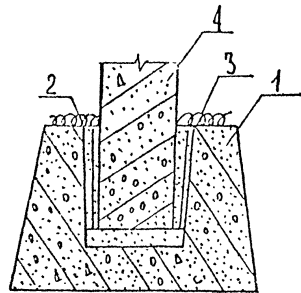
Обогрев бетона стыка красны в стакане фундамента
